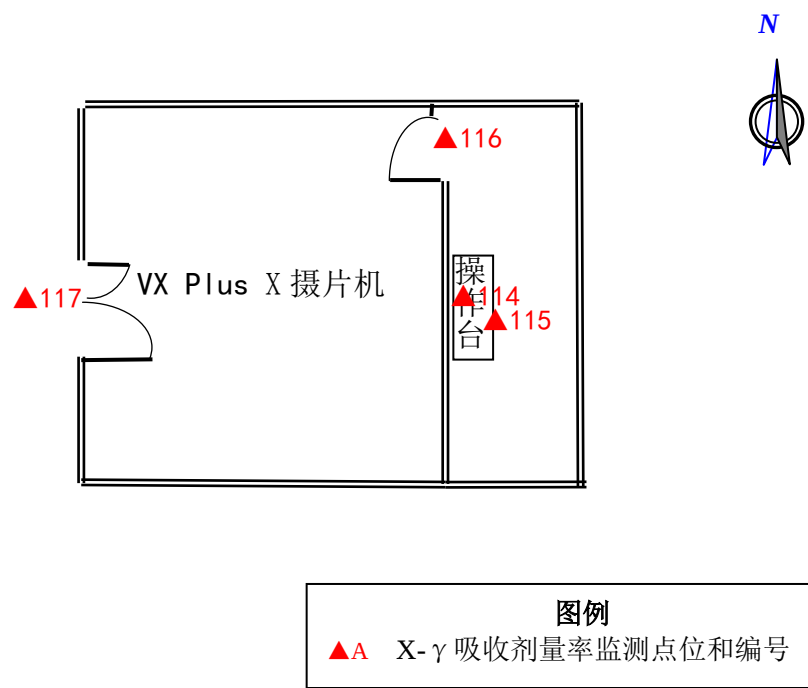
VX Plus X 摄片机房平面布置简图及监测点位图
